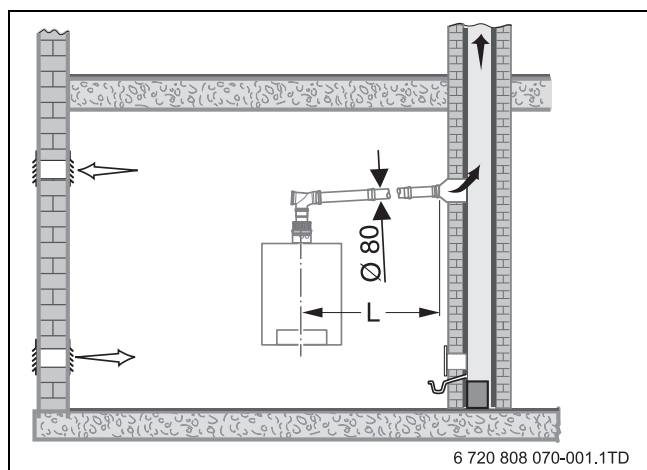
Montážní varianta se stavební sadou GA + ÜB-flex
